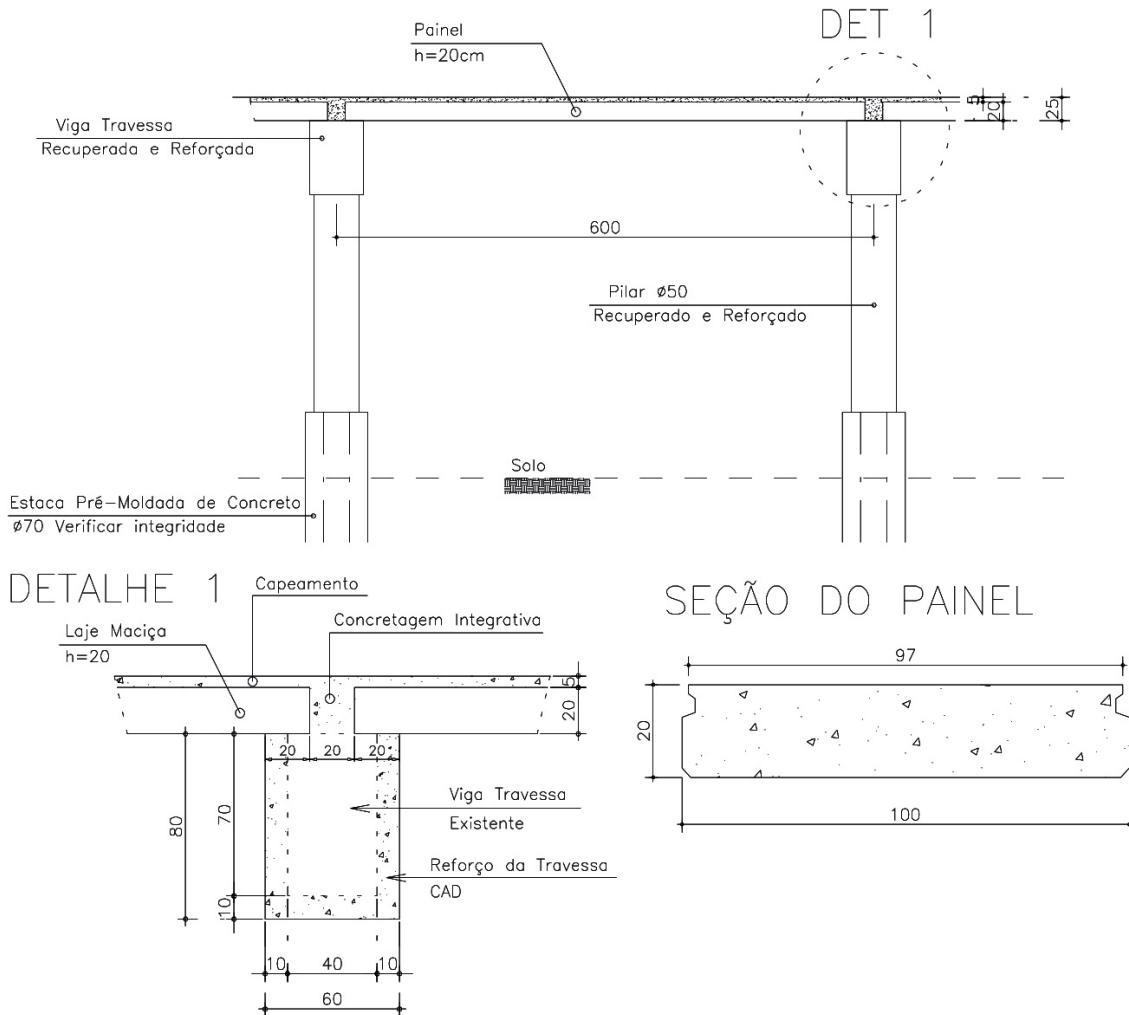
Seção longitudinal e detalhe do painel pré-moldado.
